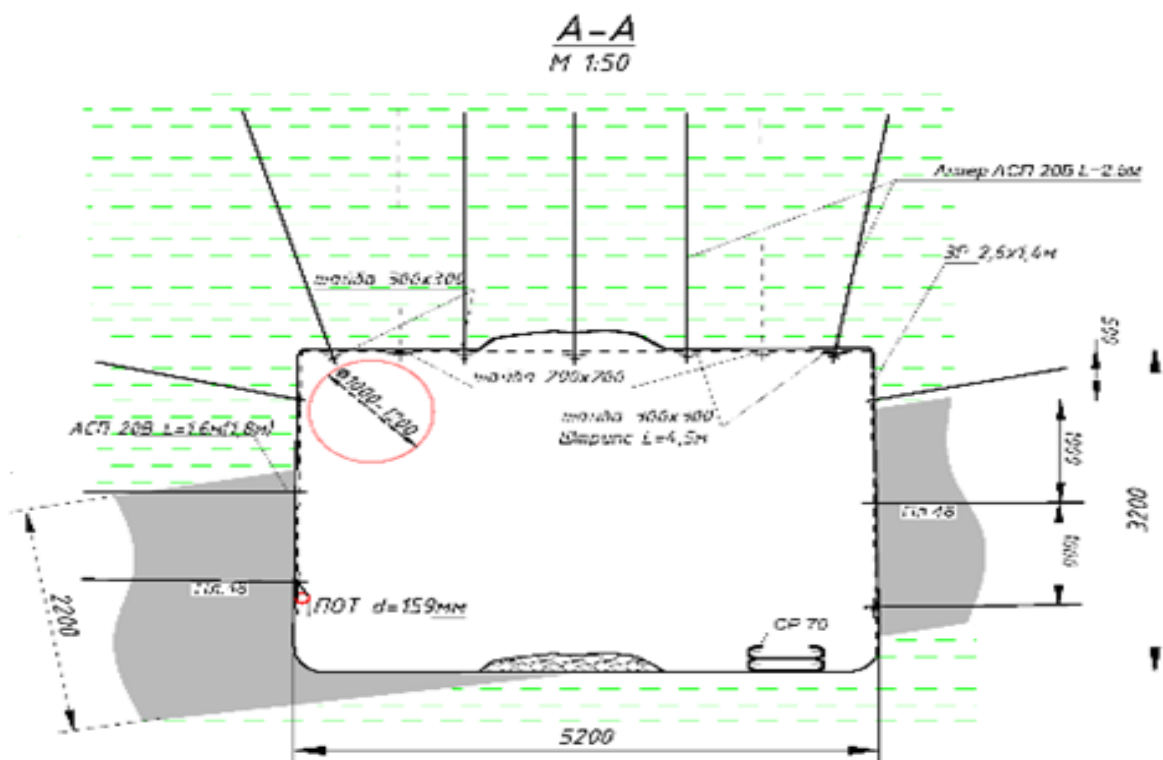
Паспорт крепления выработки пятью анкерами по кровле и шестью анкерами по бокам выработки
